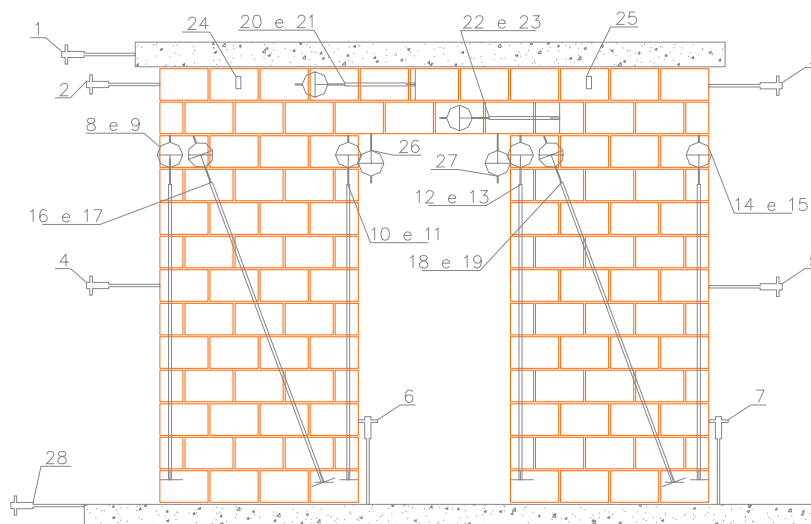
Disposição da instrumentação dos painéis da 2ª e 3ª configurações de ensaio.
